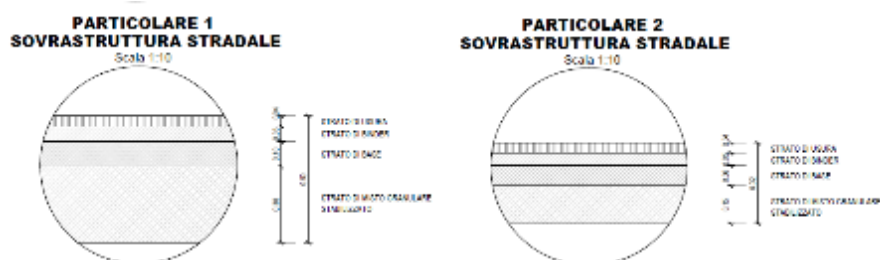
Dettaglio delle pavimentazioni del corpo stradale
